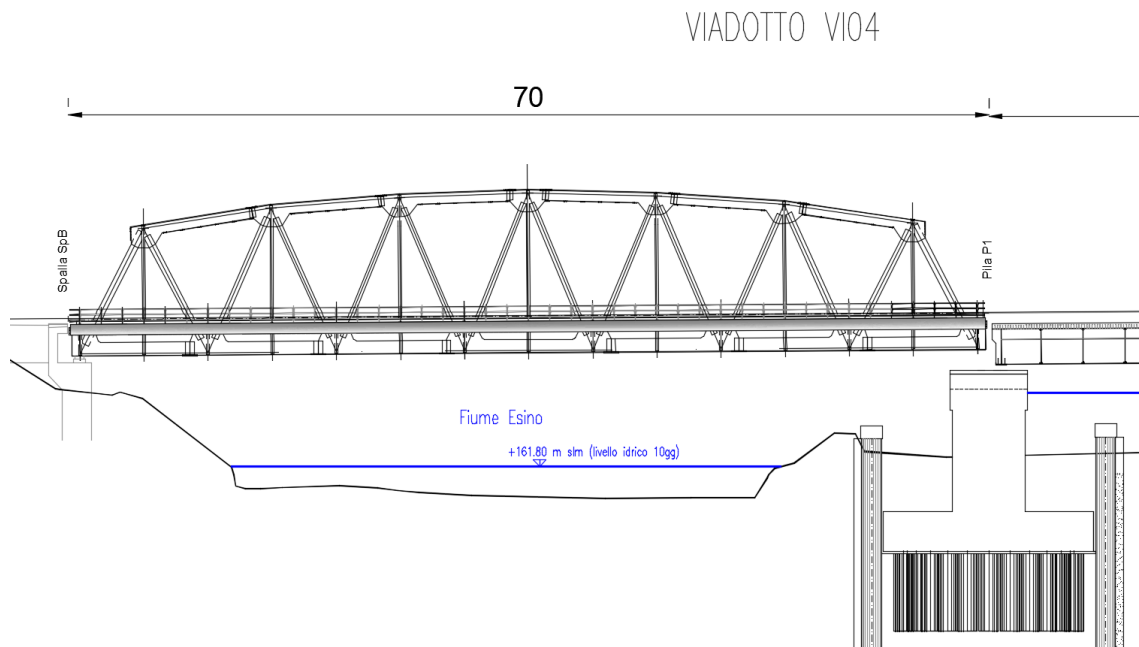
Prospetto del viadotto VI04: livello idrico di cantiere e opere provvisionali.
